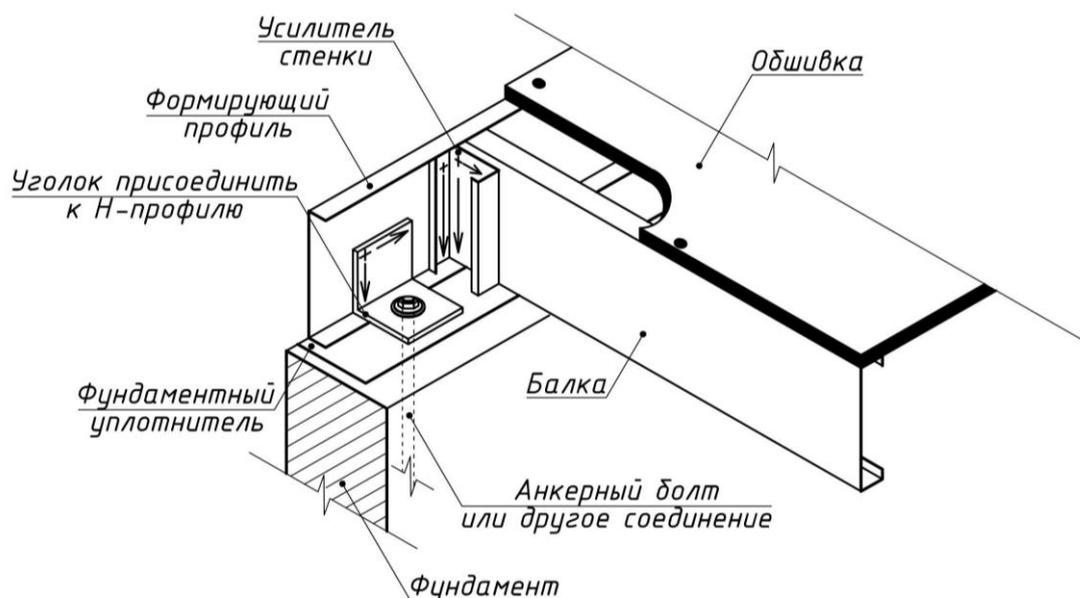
Узел П 2. Крепление перекрытия к фундаменту
